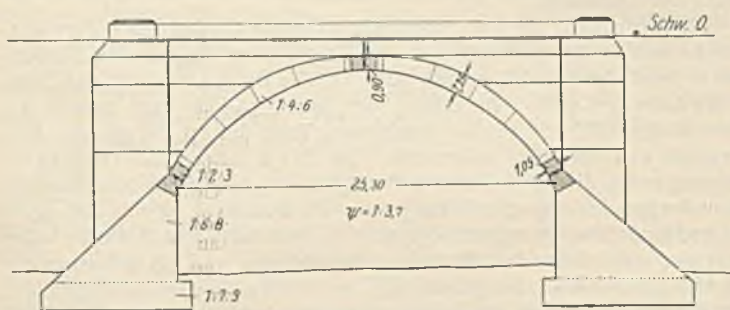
Dreigelenkbogen einer Eisenbahnbrücke bei Bautzen i. Sa., als Beispiel eines Zuggewölbes ohne Bewehrung.
